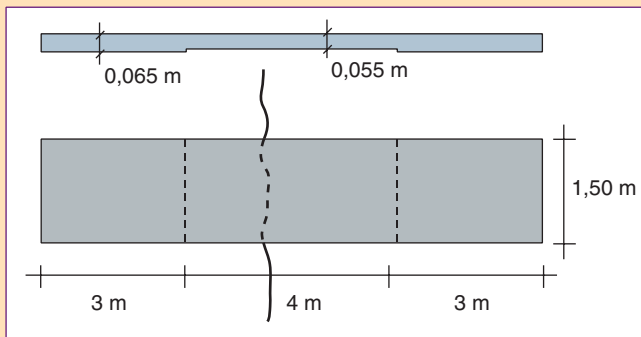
Plan de la planche d'essai. La partie centrale non adhérente chevauche une fissure de la chaussée ancienne. Les distances sont indiquées en mètres.
